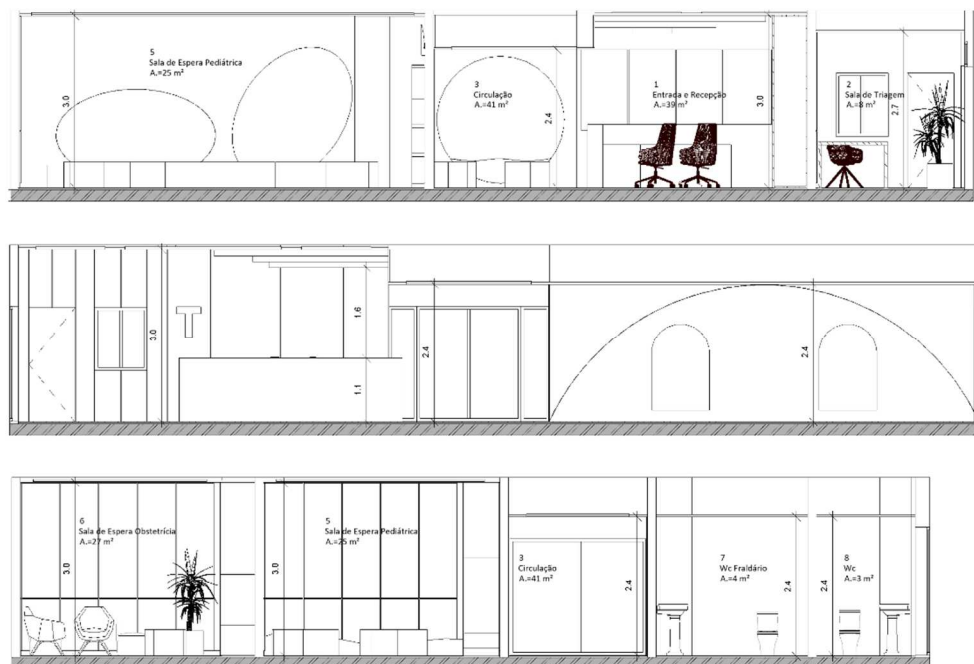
Desenho de projeto, Cortes A , B e C de Arquitetura Proposta. Fonte: Autora.
